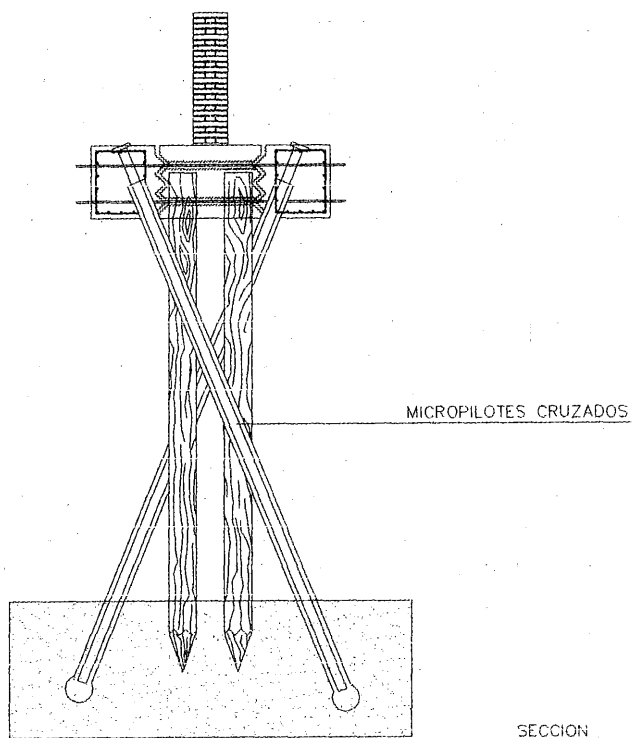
Recalce de una cimentación profunda (realizado con pilotes de madera) mediante un recalce profundo consistente en micropilotes con encepado postensado de hormigón armado.
